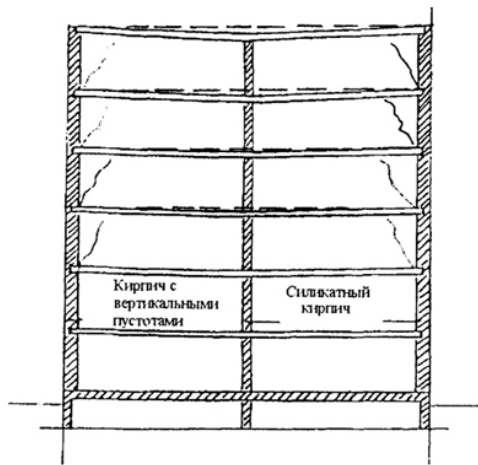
Схемы трещин, возникших в стенах от воздействия перекрытий
